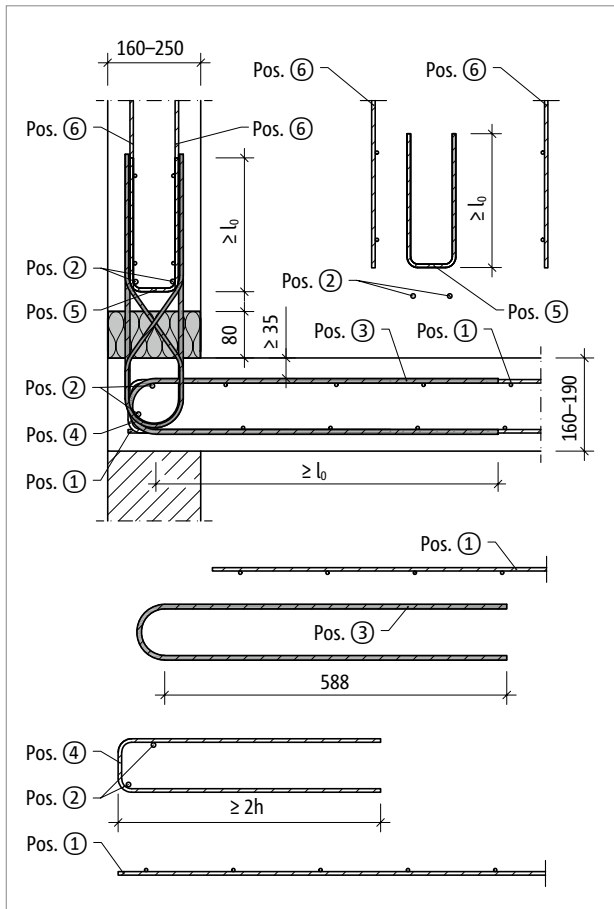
Schöck Isokorb® T Typ A: Bauseitige Bewehrung innenliegend
